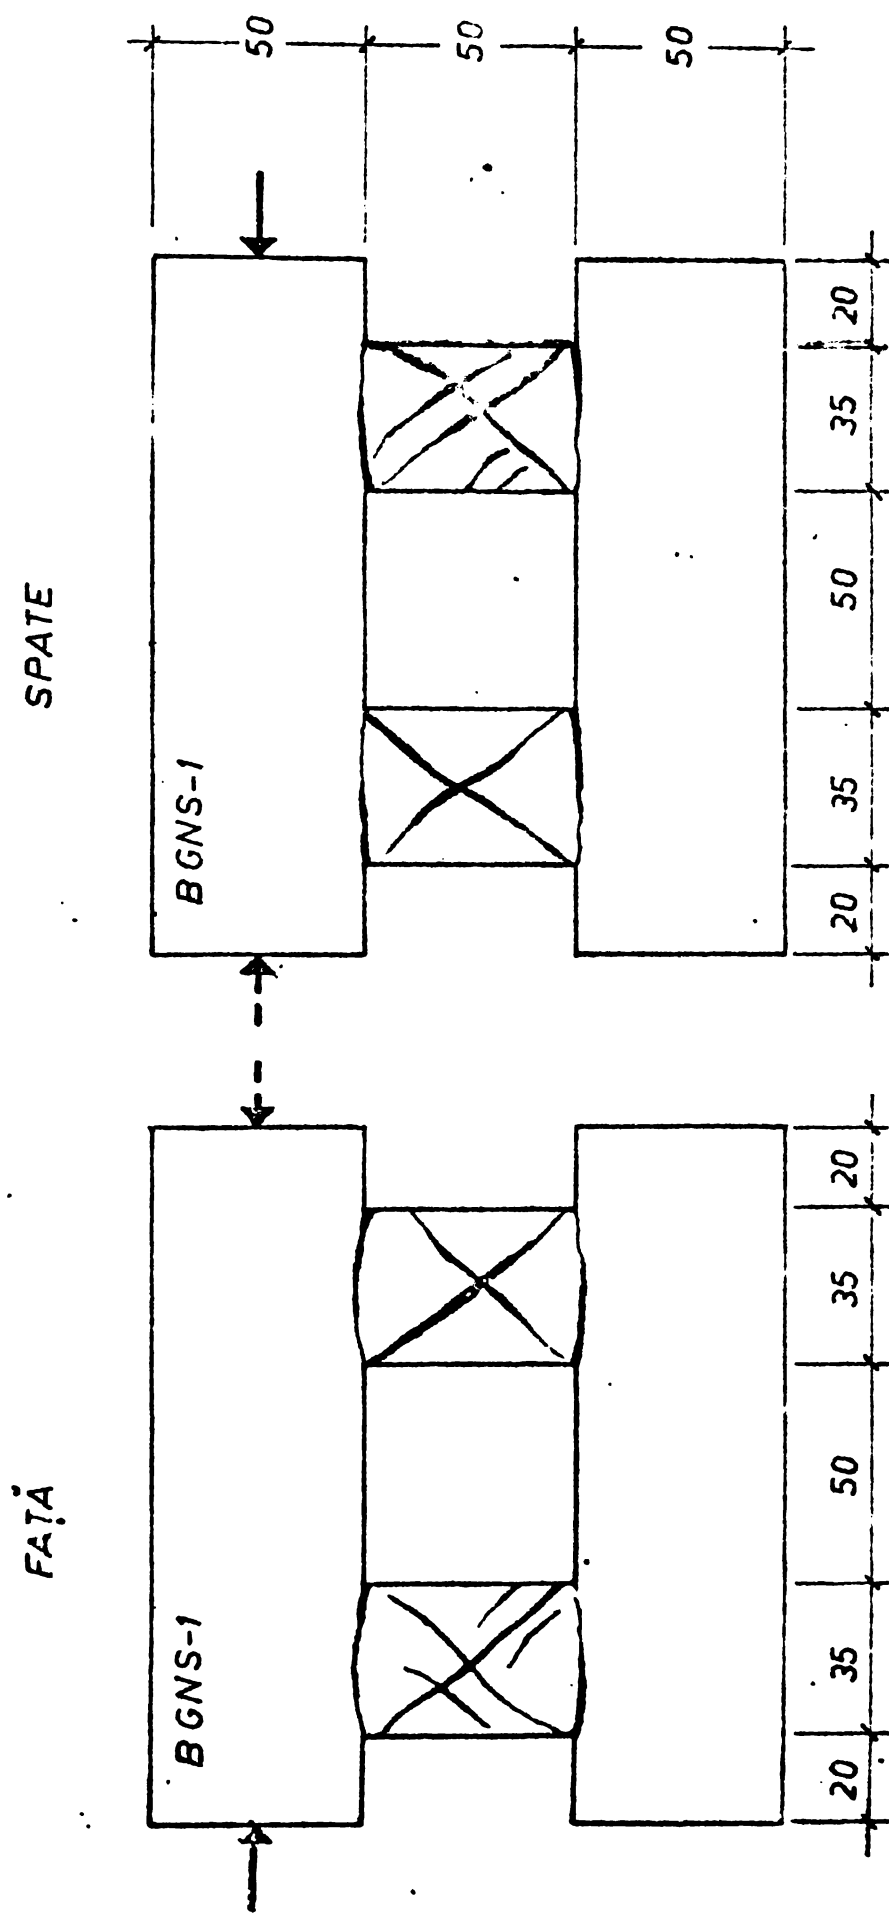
MODUL DE FISURARE A BUIANDRUGILOR ELEMENTULUI BGNS-1 LA RUPERE
